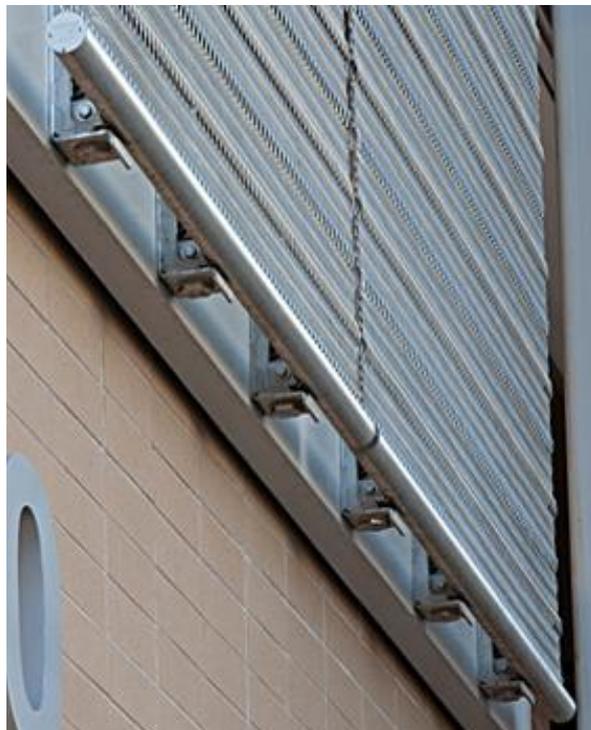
Sistema de Fijación en Tensión con estructura de soporte compuesta por tubos de acero inoxidable.
